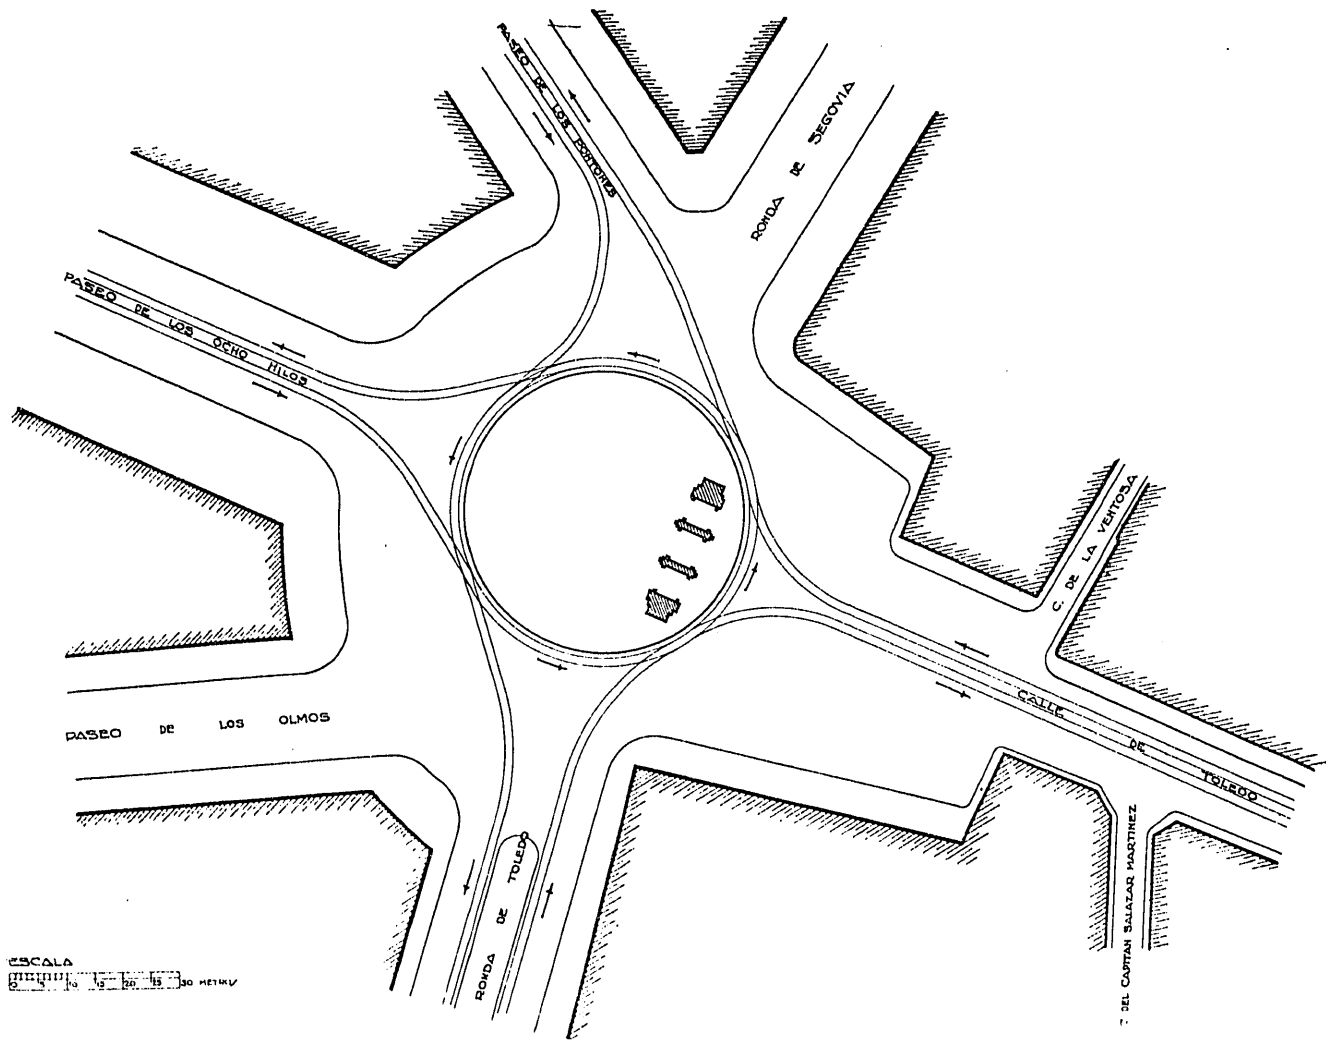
Planta actual de la Glorieta de la Puerta de Toledo
